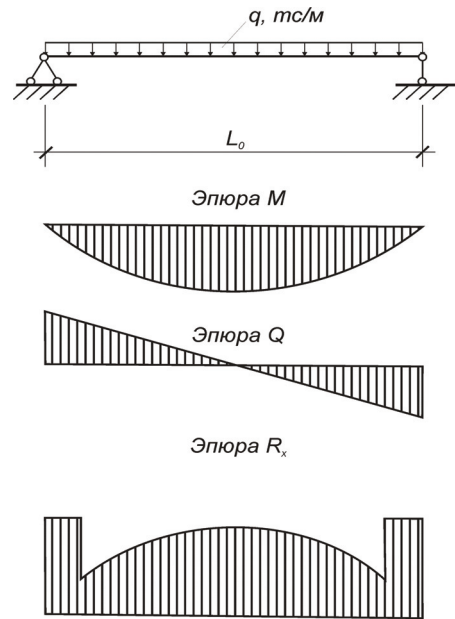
Расчетные и контрольные эпюры для однопролетной железобетонной балки.
